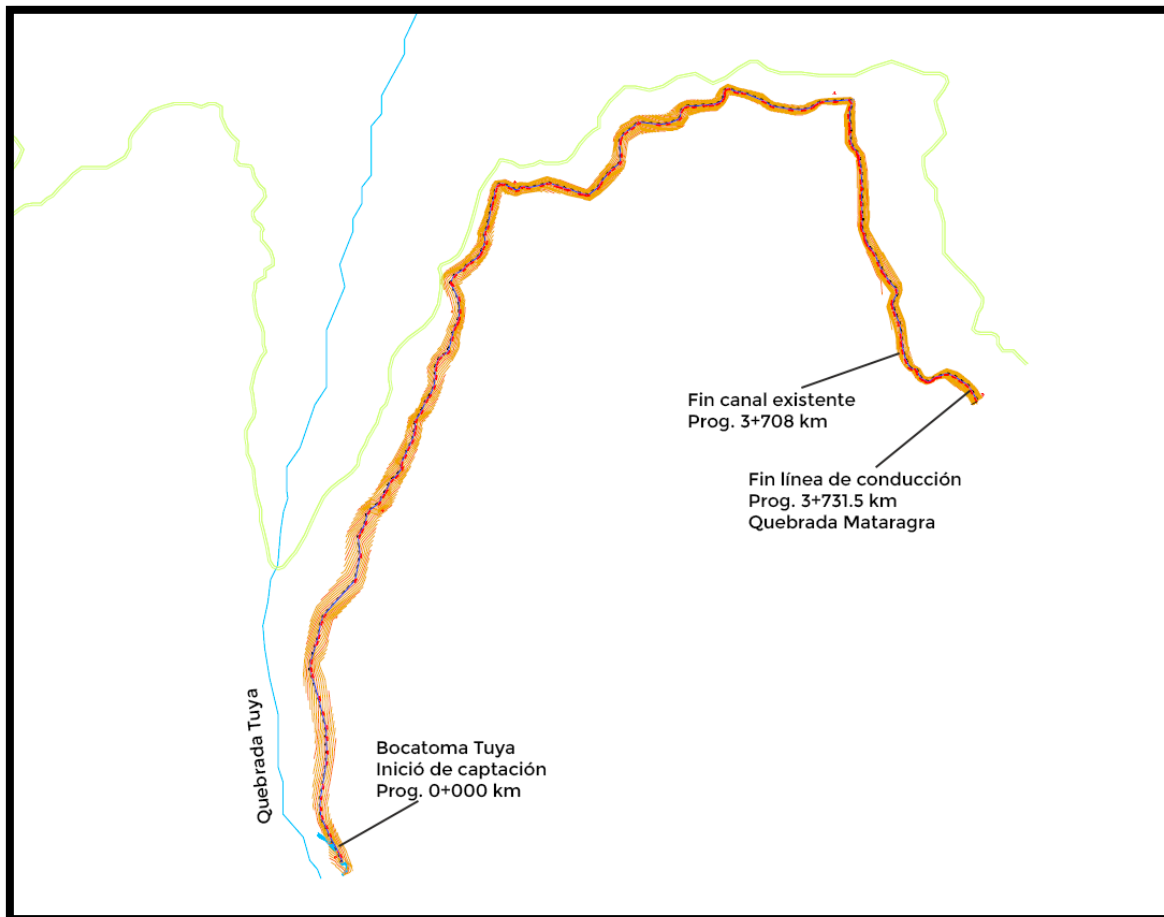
Vista en planta del levantamiento topográfico (Fuente: Elaboración propia.)
